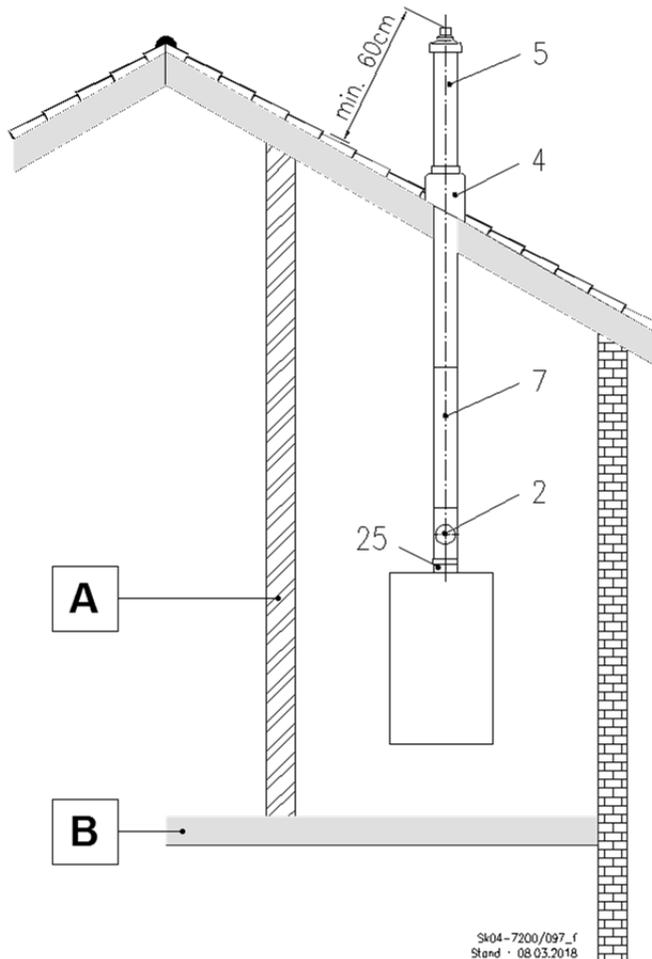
C_{33x} Centrale de chauffage de toit avec modèle vertical traversant un toit incliné
